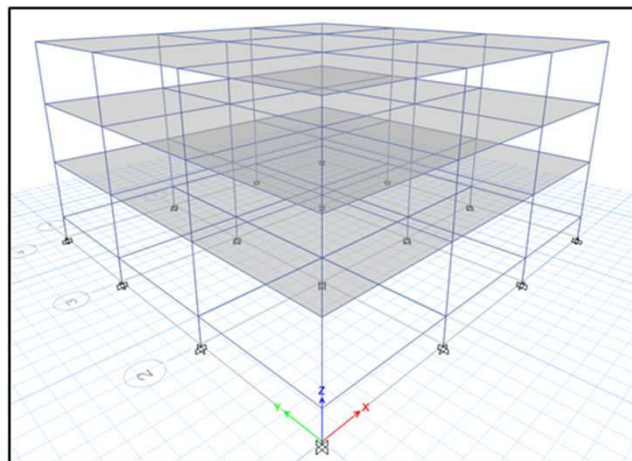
Modelo con base empotrada incorporando vigas de amarre a nivel de contrapiso.
